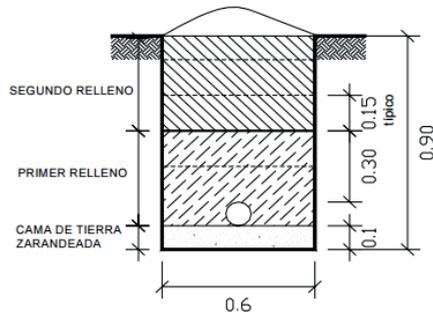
Detalle instalación de tubería para red de acueducto rural
